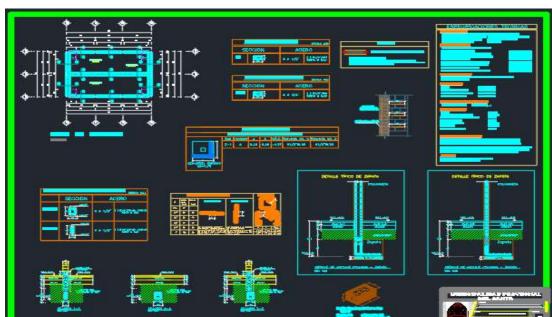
Plano de Cimentaciones de Área de Almacén.
